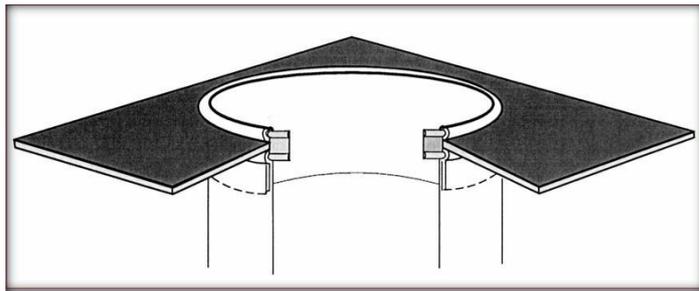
FIJACIÓN DE MANGAS CON FLEJE METÁLICO.⁵³
